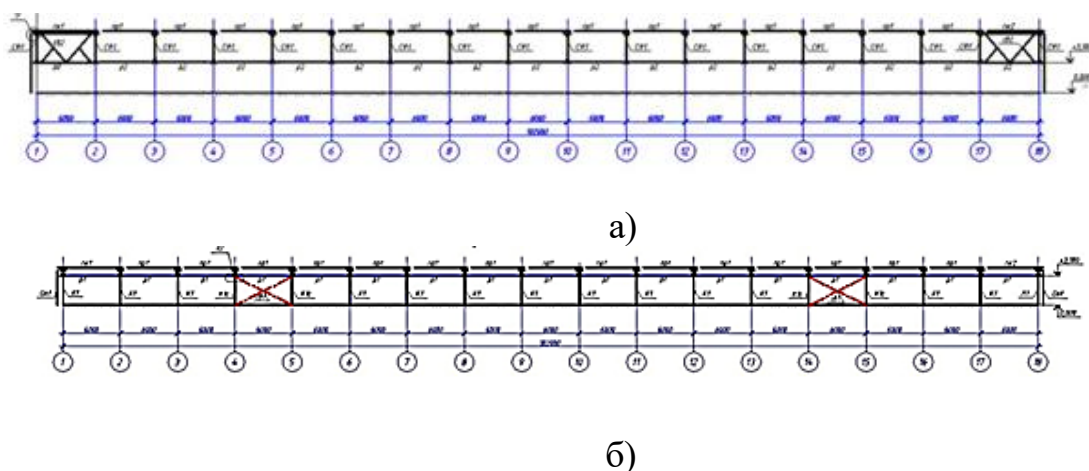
Схема розташування зв'язків у рівні верхнього пояса ферм
